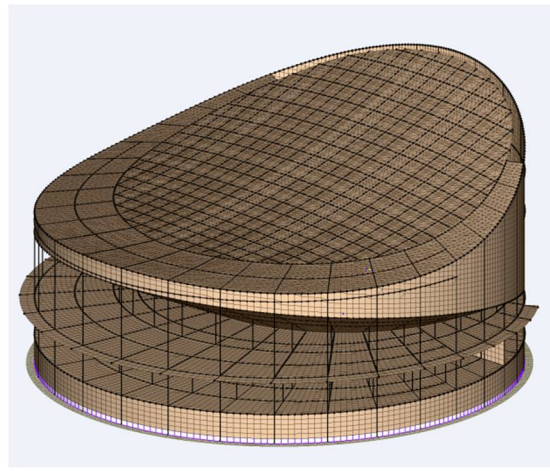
Формирование пространственной ветровой нагрузки на фасад здания цирка
